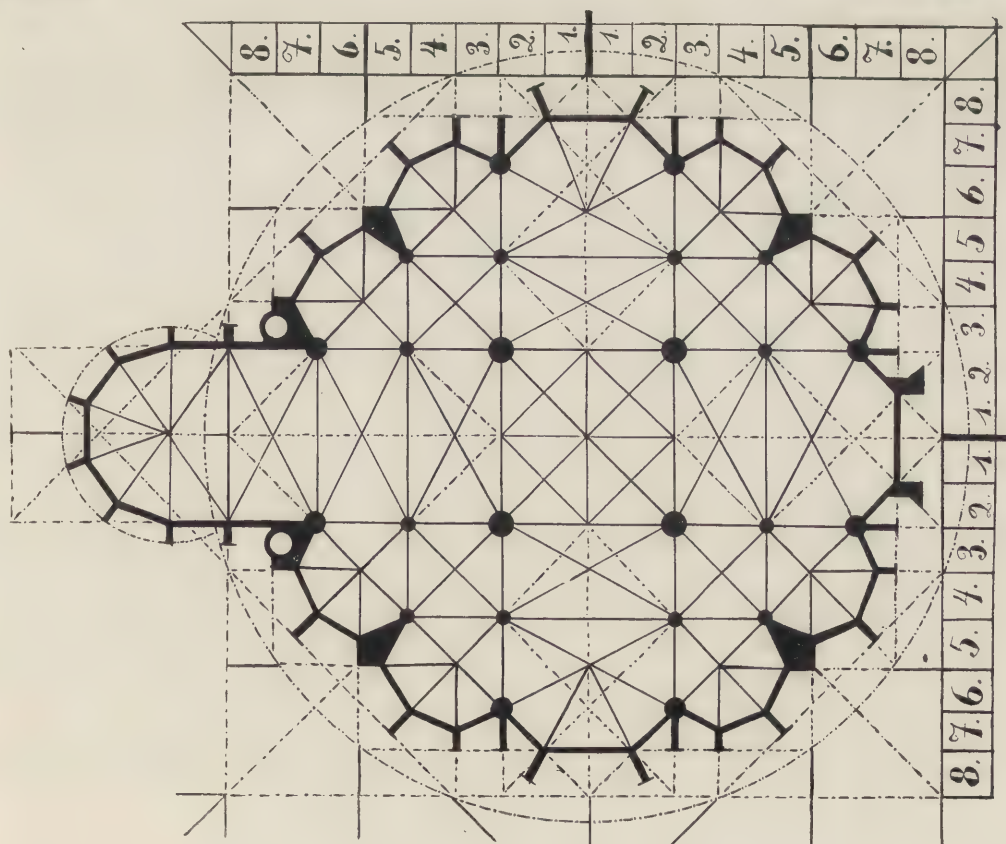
Schema zum Grundriss der Liebfrauenkirche zu Trier.
